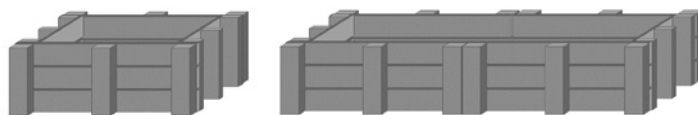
Exemplo de componente estrutural individual. O número e a forma das travessas horizontais, o número e a forma das barras verticais, bem como as dimensões relativas, podem ser adaptadas tendo em conta as características dos materiais de construção.
